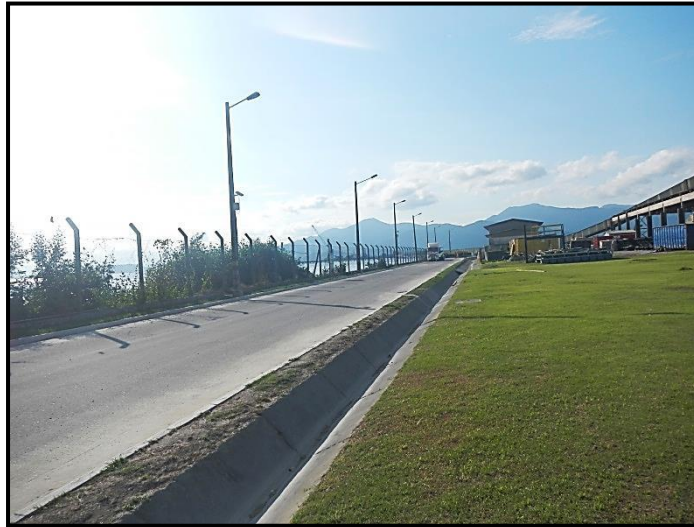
Área de implantação do novo armazém entre a Rua 1 e o armazém existente. Ao fundo vista da oficina/almoxarifado que será demolido.
